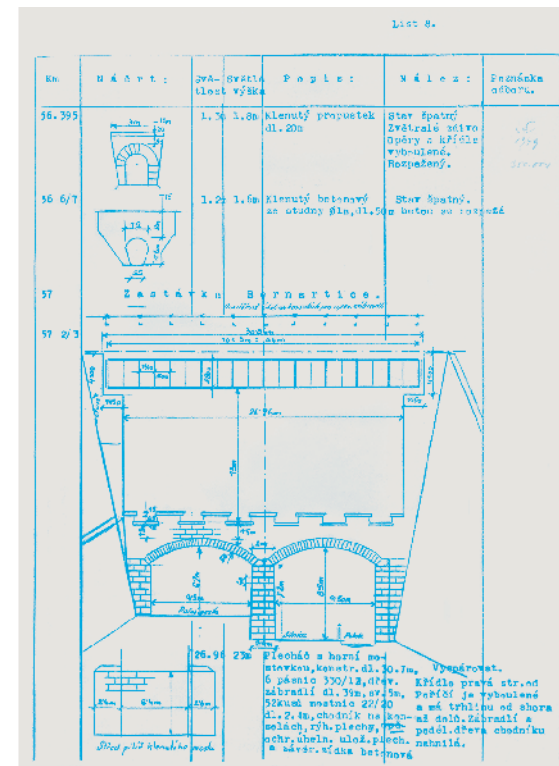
Pohled na opěru a nosnou konstrukci
